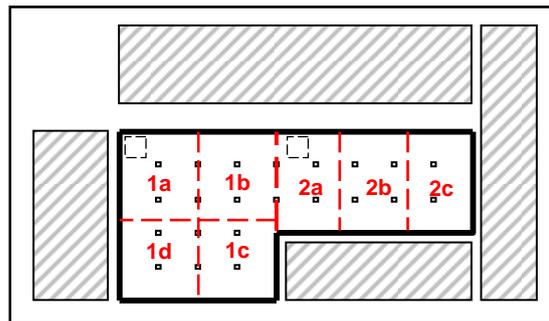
Weitere Aufteilung in Betonierabschnitte
